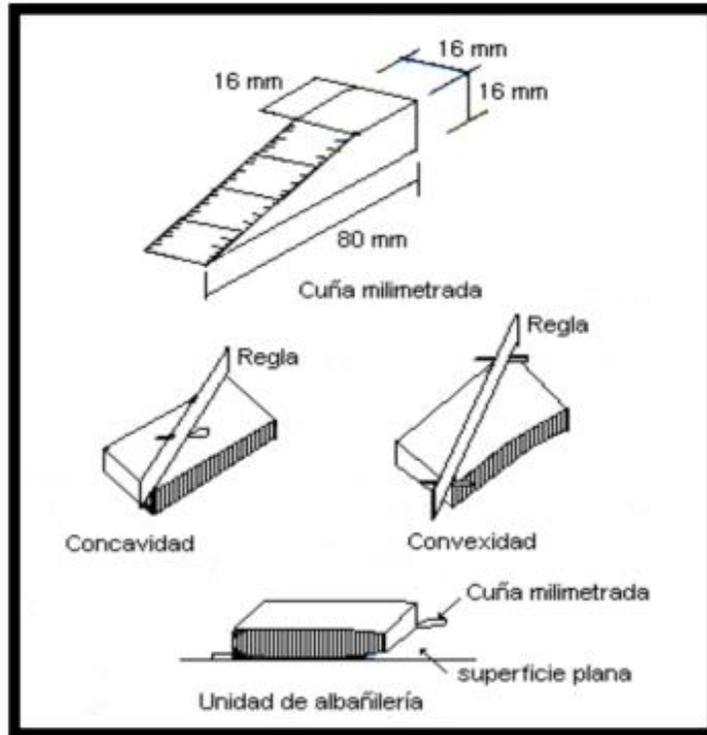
Ensayo de Alabeo en Bloques de Concreto
